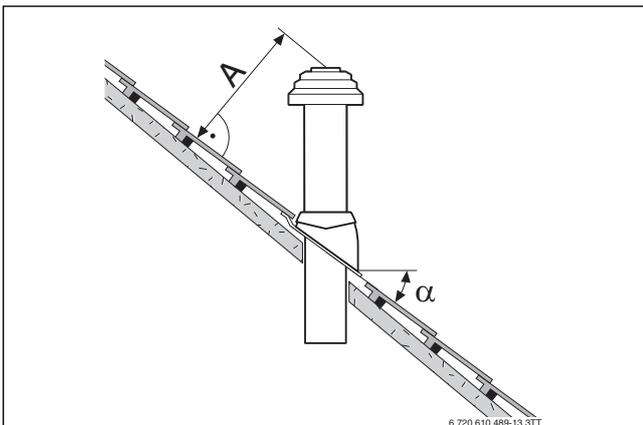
Abstandsmaße und Dachneigungen bei Schrägdach
